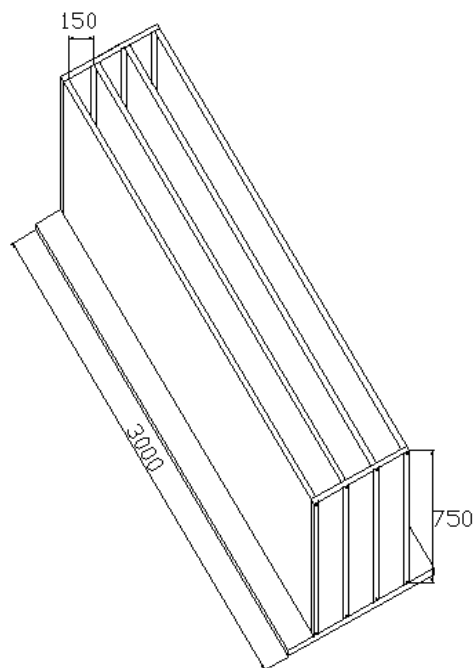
Desenho em perspectiva da forma com suas principais dimensões (mm).
